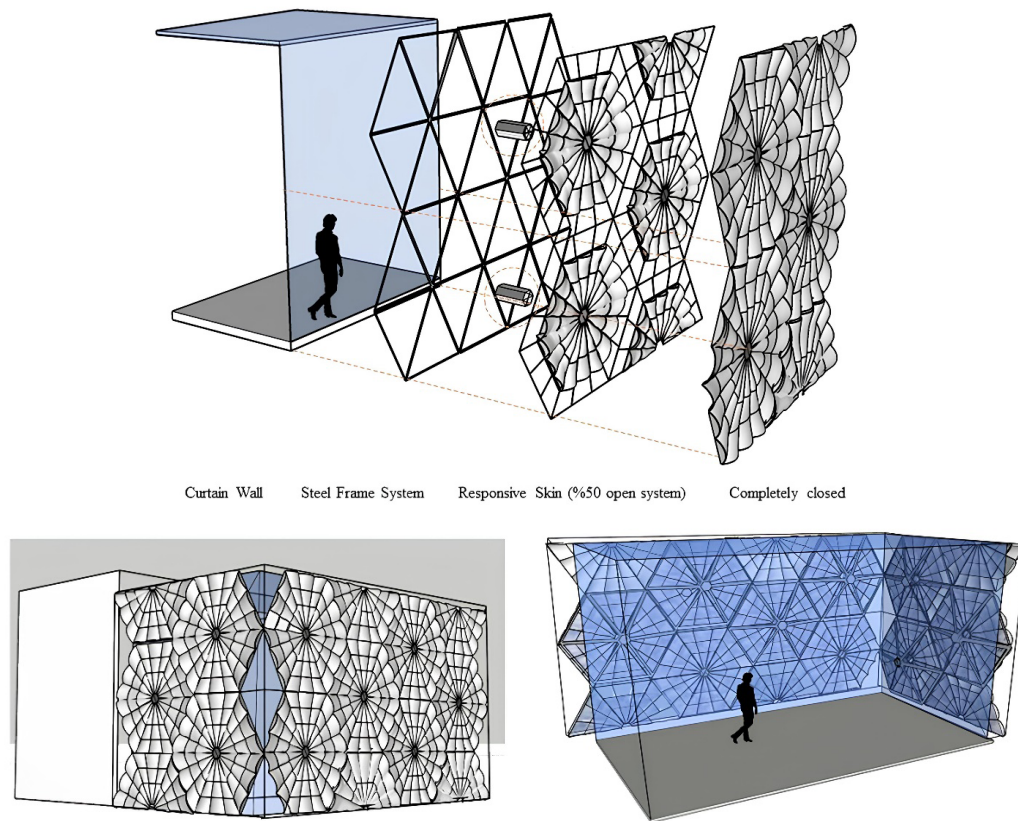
Aplicación del sistema de fachada de vidrio a la zona de la cafetería del baño Süleyman Pasha.
